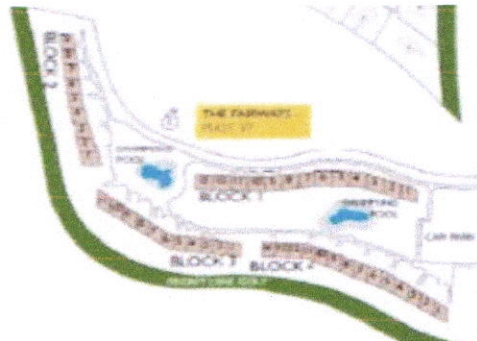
Plan de disposition d'une partie des villas (source mémoire village touristique balnéaire au andalouse 2014)
